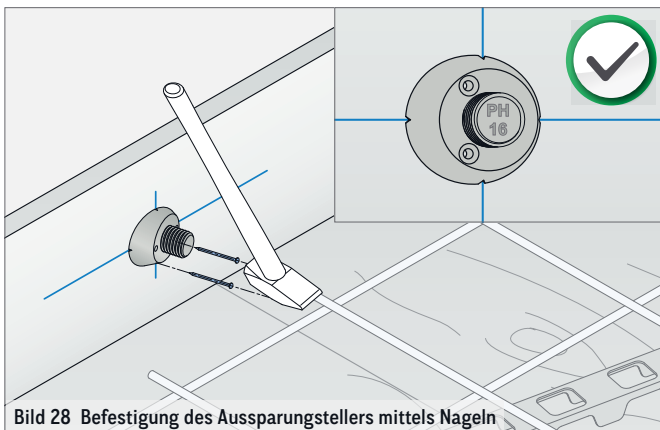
Befestigung des Aussparungstellers mittels Nageln
